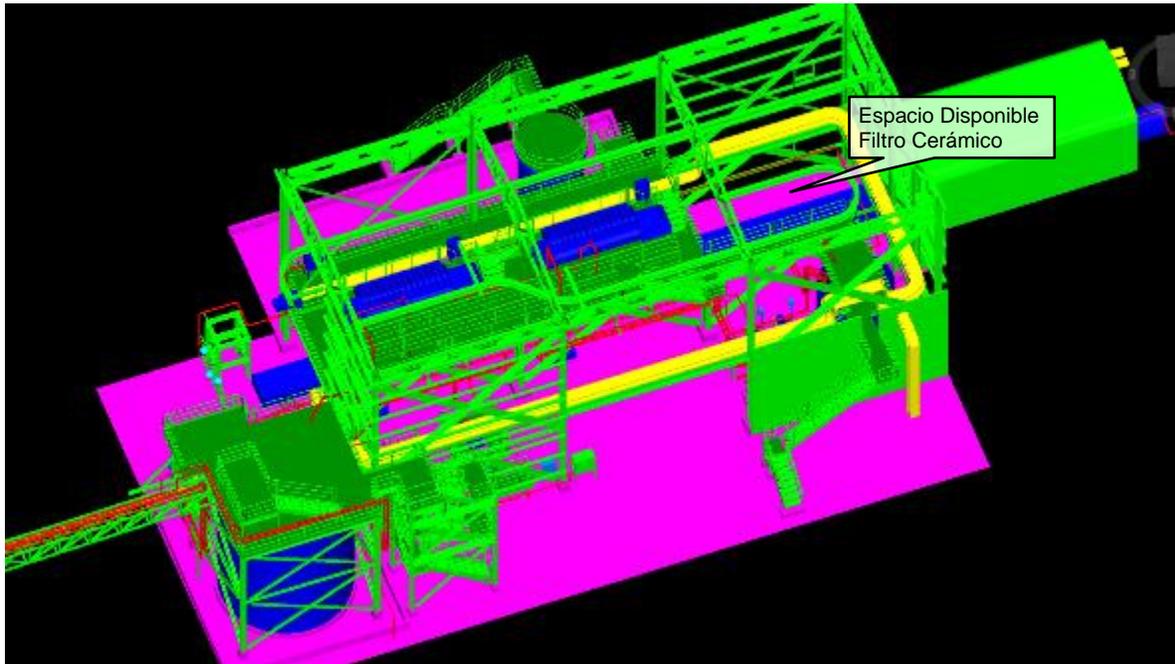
Modelo 3D Nave Planta Filtrado – Área Filtro Concentrado Cu
